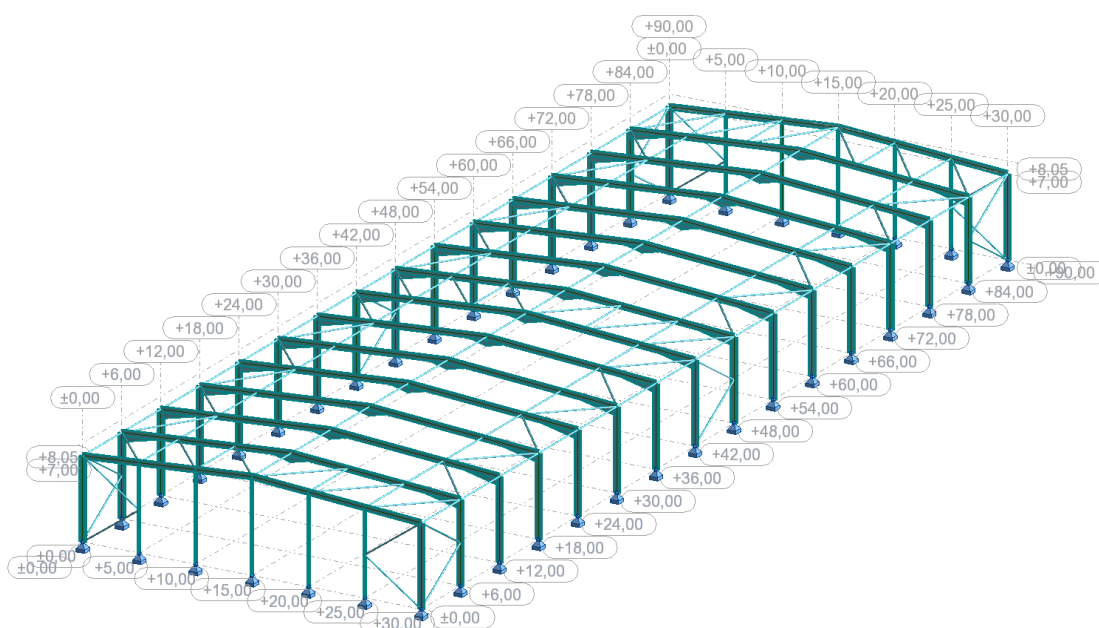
Exemplo do contraventamento aplicado - vista 3D (caso de estudo PF30-6)
